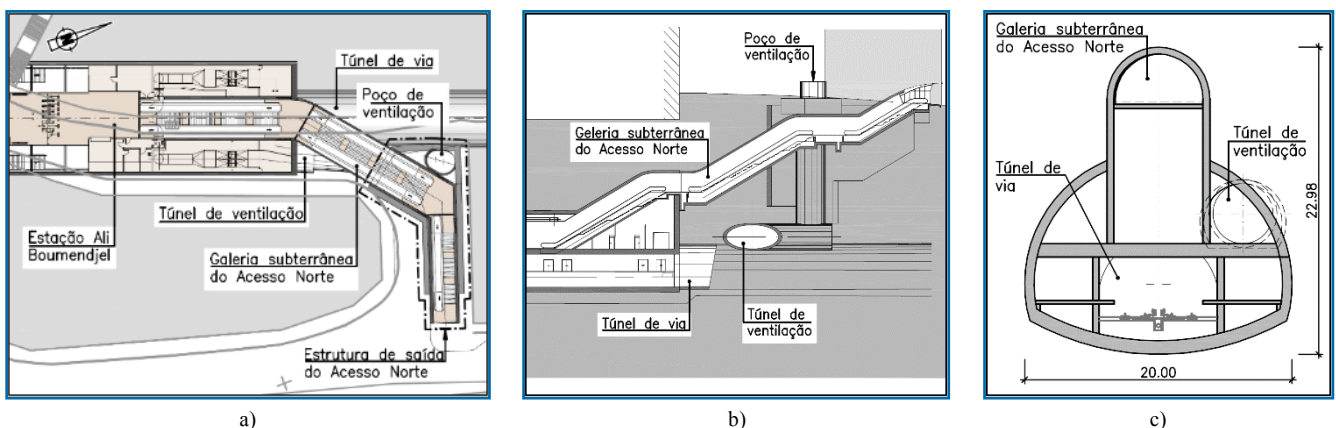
Solução preconizada no APD para o acesso Norte da Estação Ali Boumendjel: a) planta; b) corte longitudinal ao eixo do acesso; c) topo Norte da estação
